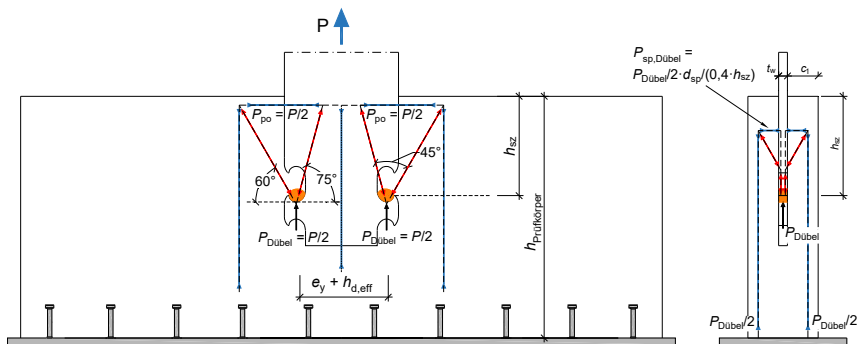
Lastabtragungsmodell des primären Betonausbruchs durch die Biegebelastung und das Spalten
